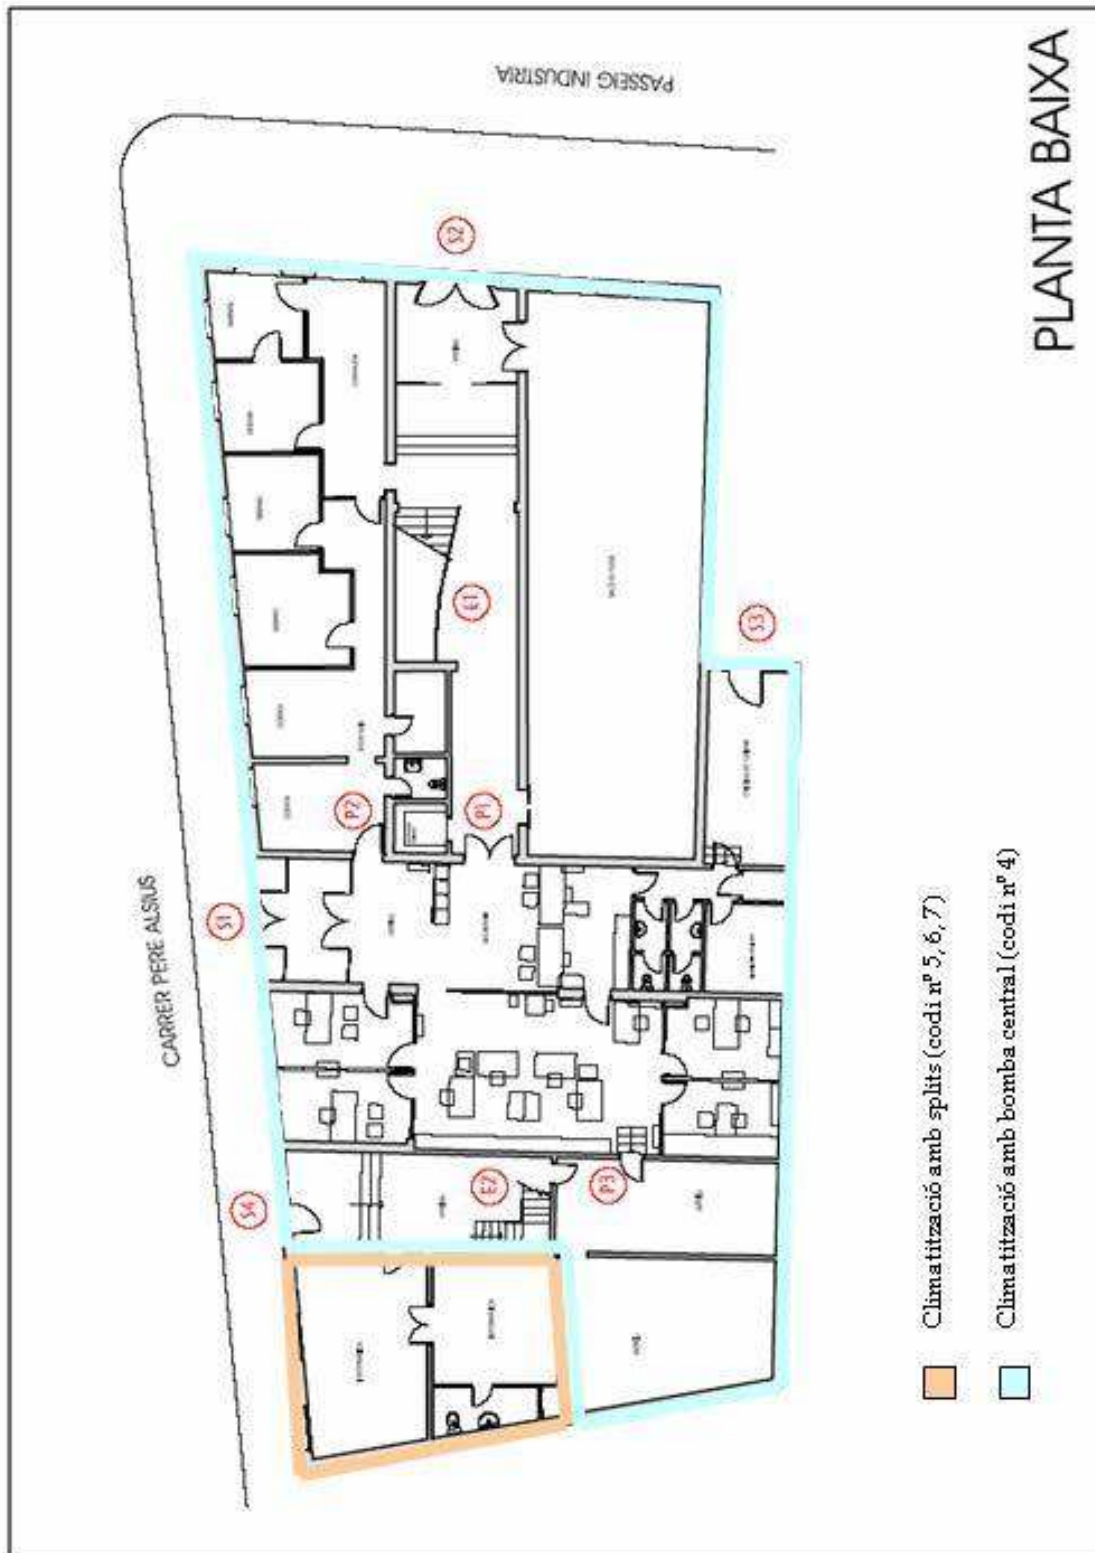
Plànol de l'Ajuntament, Planta Baixa
